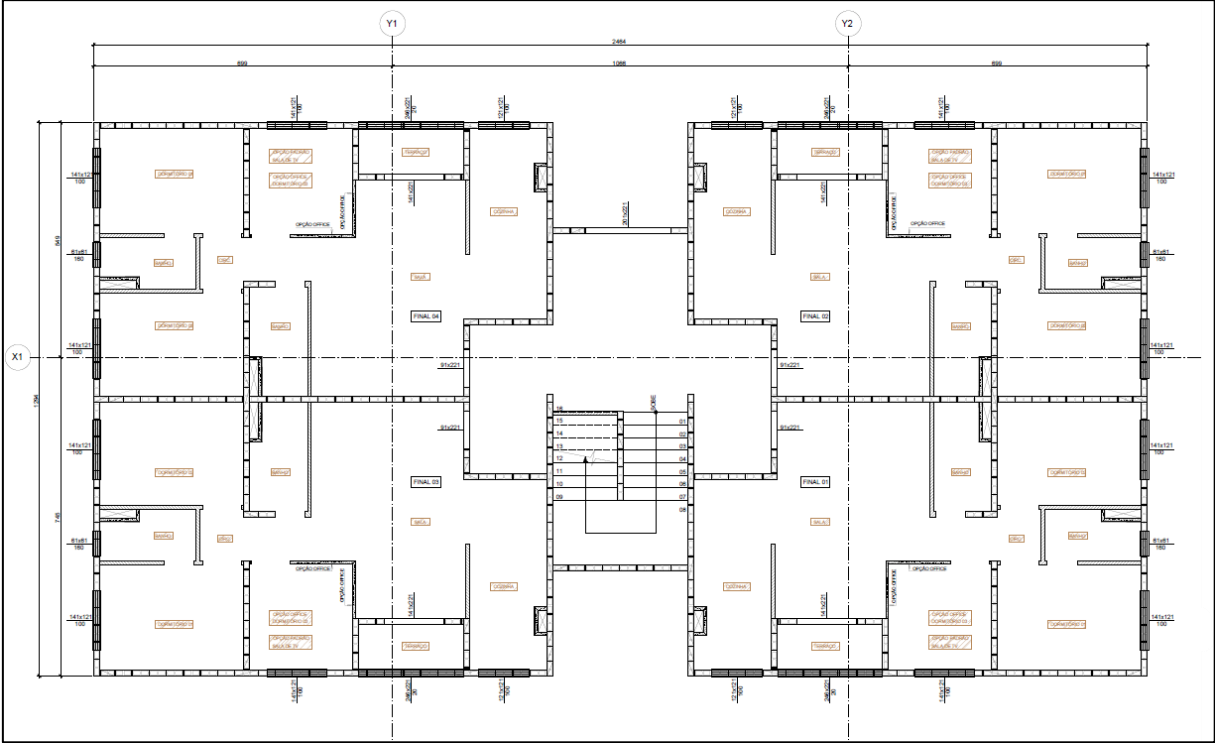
Planta do pavimento tipo em Projeto Executivo
